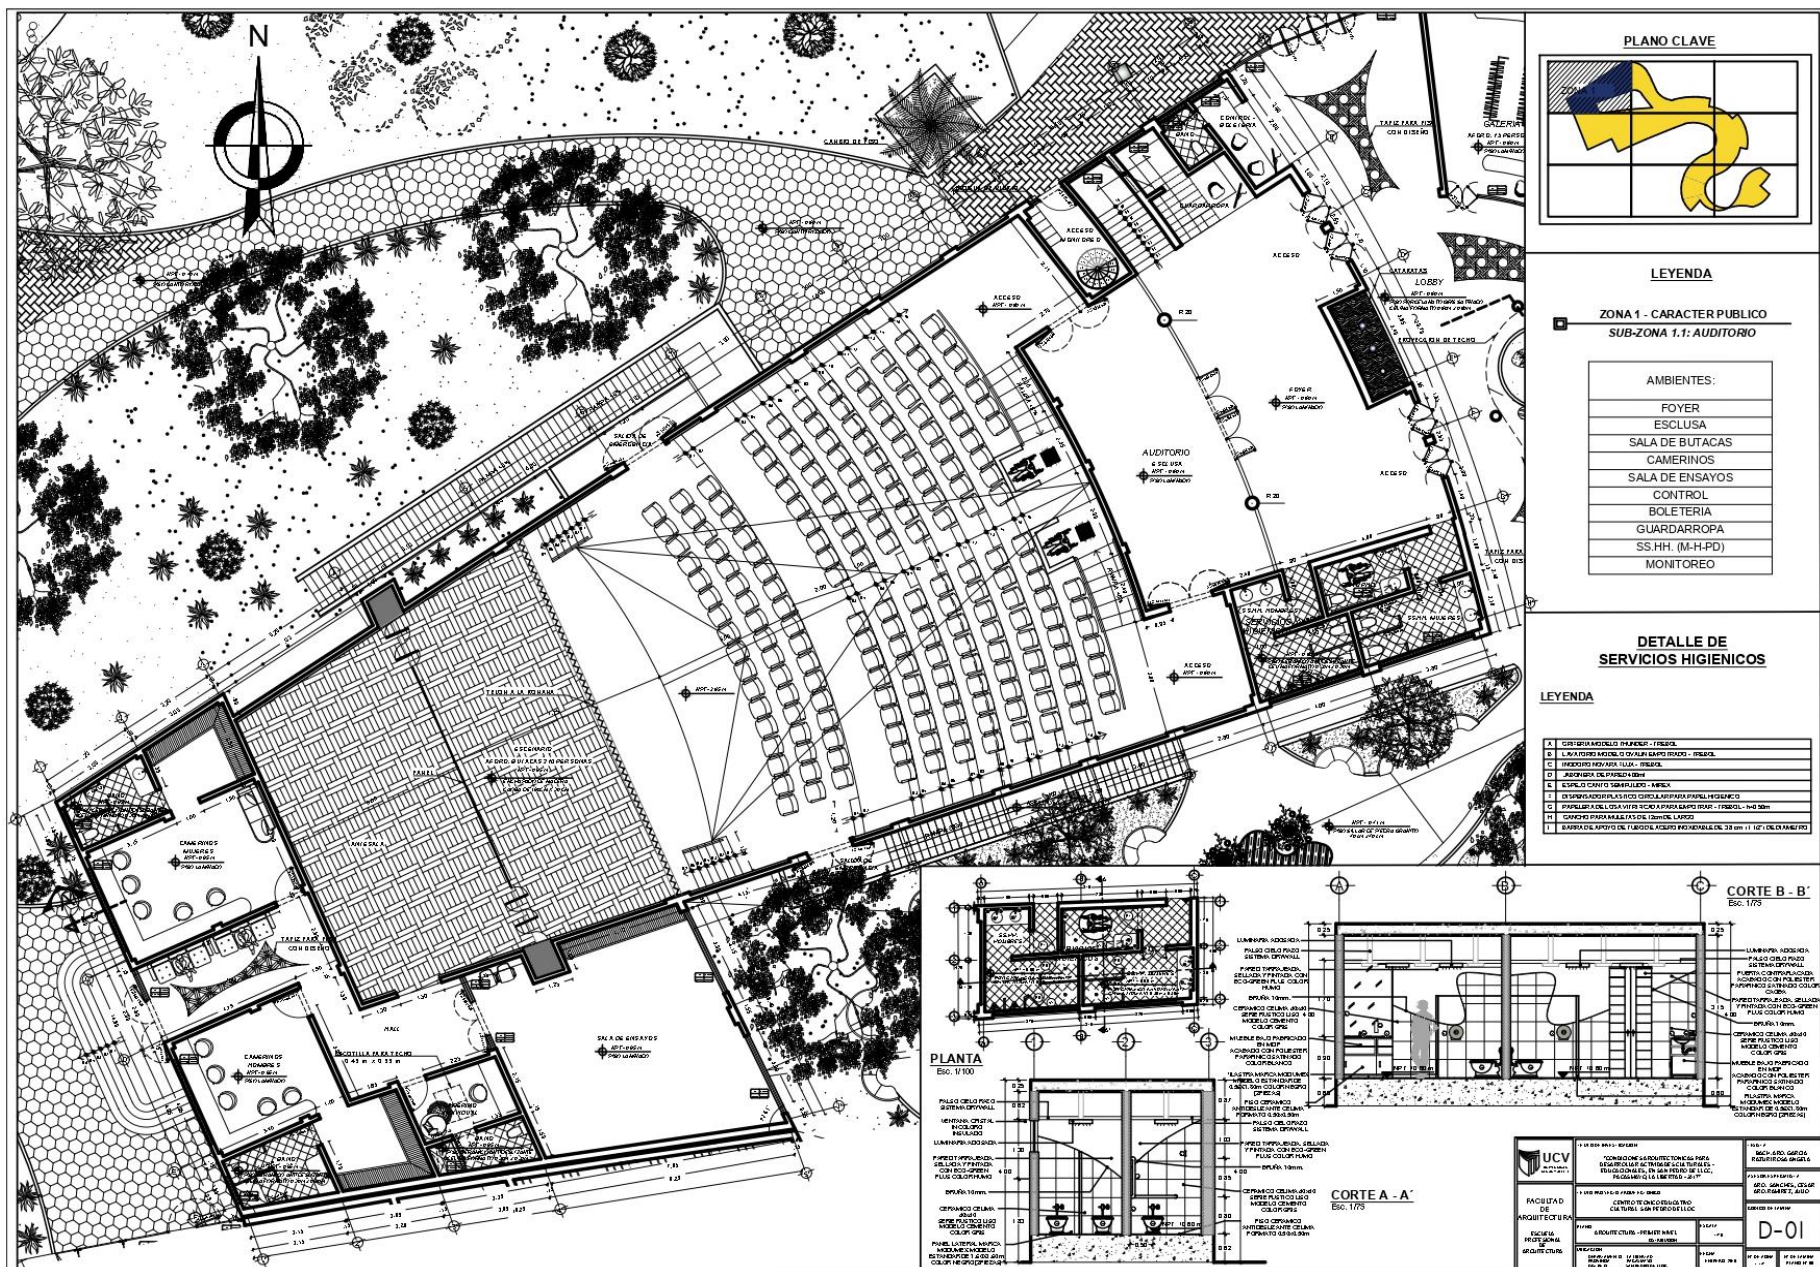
Plano de Desarrollo por Zonas - Plano N° 09 - Lamina N°: D - 01
